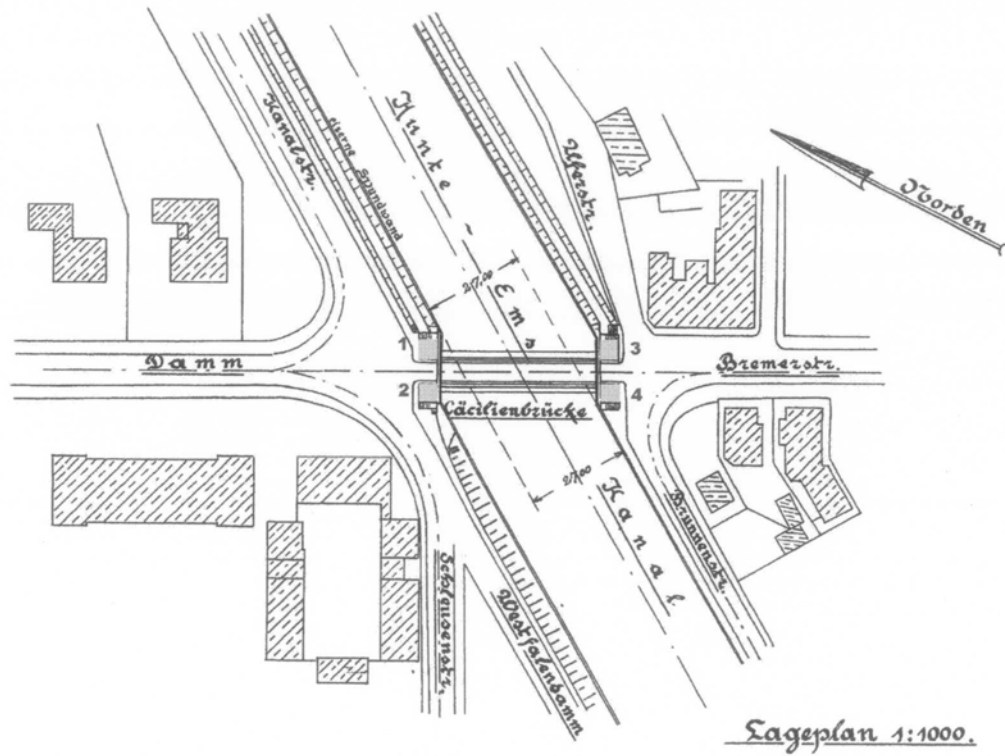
Lageplan mit Bezeichnung der Hubturmsnummern
